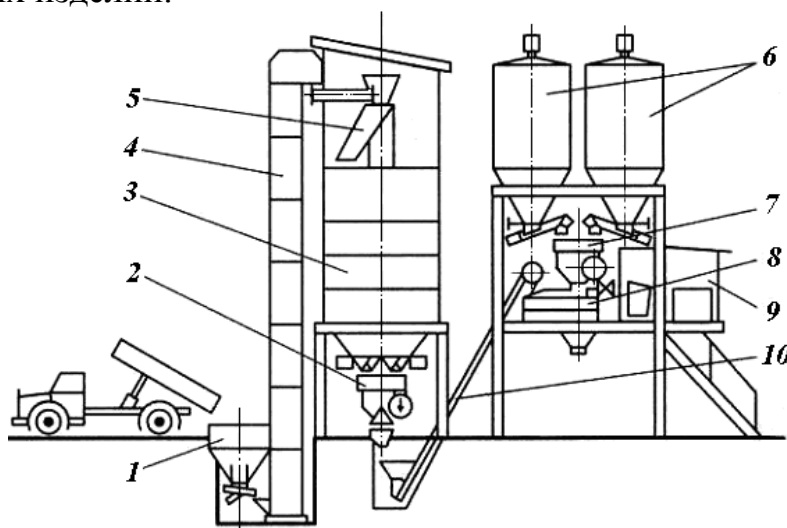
Схема двухступенчатой бетоносмесительной установки: 1 – приемный бункер; 2 – дозатор песка и щебня; 3 – расходный бункер; 4 – многоковшовый конвейер; 5 – поворотная воронка; 6 – силосы цемента; 7 – дозатор цемента; 8 – бетоносмеситель; 9 – кабина управления; 10 – скиповый подъемник
